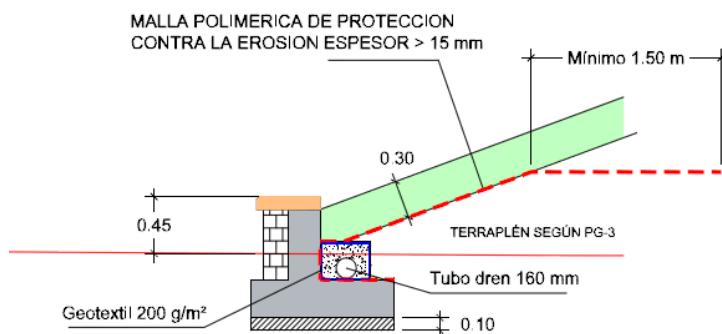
Construcción del muro de piedra en el talud para la protección contra avenidas.
